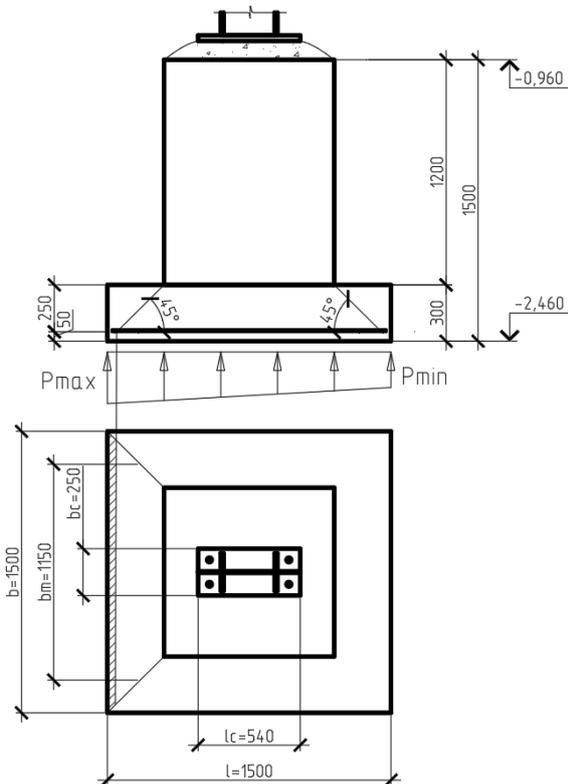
Схема к расчету низкого фундамента на продавливание подколонником
